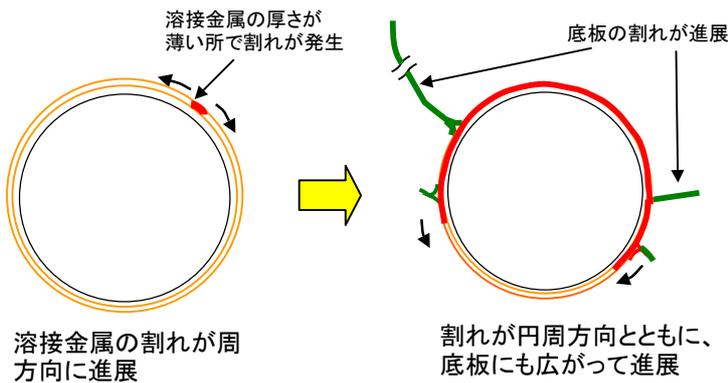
(2) 補助建屋排気筒のひび割れおよびドレン管の接続不良の原因と対策について
